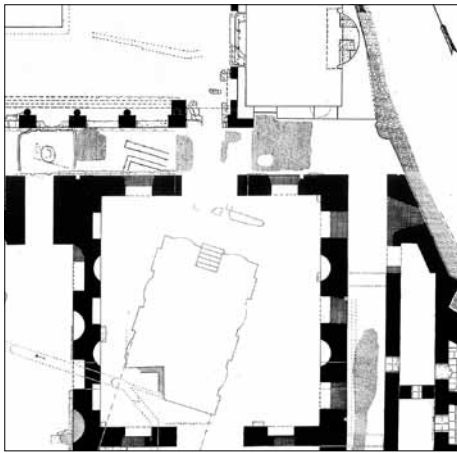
/11 Grundriss des Atriums nach Richard Delbrück, 1921.
